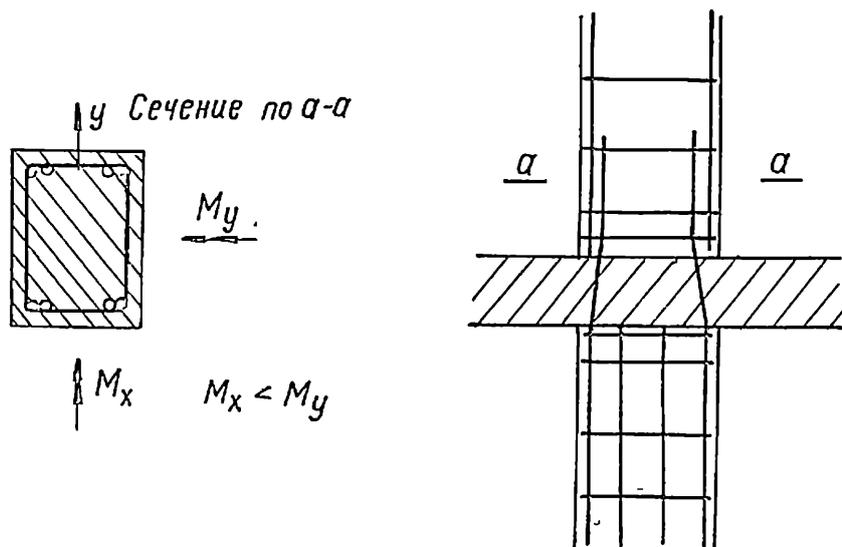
1. Стыки внахлестку в колоннах на уровне плит перекрытий. Угловые стержни пропускаются с пергибами
